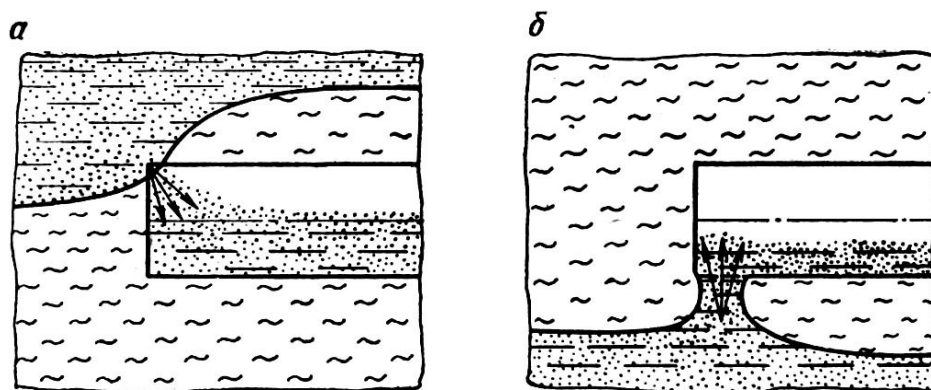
Схемы прорывов плавунуна в горные выработки:
